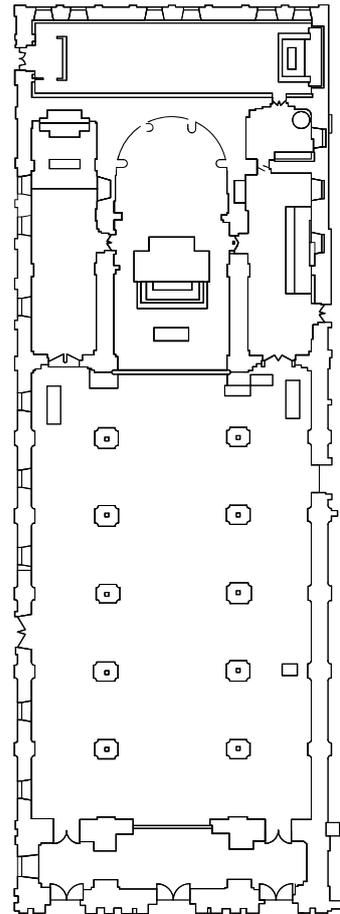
Planta Arquitectónica Iglesia de Santo Domingo Cuenca.
